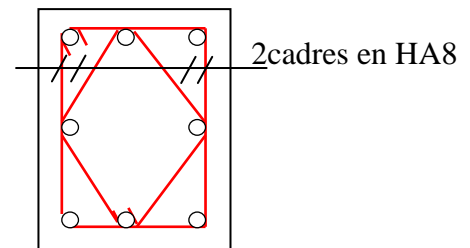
Disposition des cadres dans les poteaux
